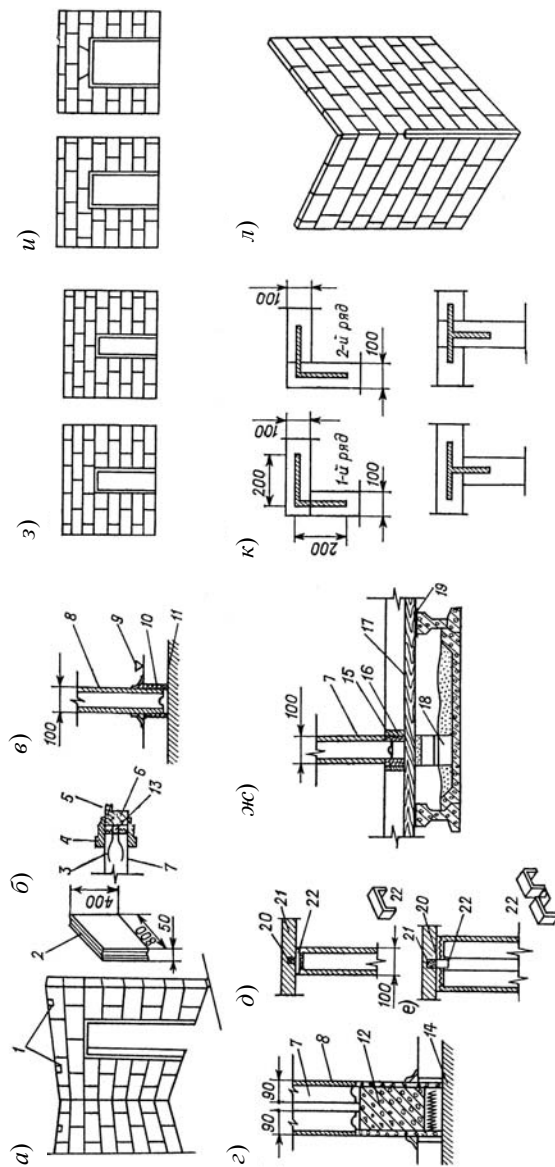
Общий вид перегородки из мелкозернистых гипсовых, гипсошлаковых и шлакобетонных плит: *a* – общий вид; *б* – крепление дверной коробки к перегородке; *в* – установка межкомнатной перегородки на перекрытие из железобетонных плит; *г* – установка межквартирной двухслойной перегородки на опорную железобетонную балку; *д* – крепление однослойной перегородки к железобетонному перекрытию; *е* – крепление двухслойной перегородки к железобетонному перекрытию; *ж* – установка перегородки параллельно балкам перекрытия; *з* – устройство перемычек при ширине проема менее 0,8 длины плиты; *и* – устройство перемычек при ширине проема более 0,8 длины плиты; *к* – угловое и тавровое скрепление плит анкерами; *л* – сопряжение перегородок под углом; *1* – скобы крепления; *2* – гипсовая плита; *3* – печная проволока, закладываемая в шов кладки; *4* – наличник; *5* – коробка; *6* – гвоздь $L = 100$; *7* – плита; *8* – затирка; *9* – уровень чистого пола; *10* – звукоизоляционная прокладка; *11* – раствор; *12* – железобетонная балка; *13* – заделка паклей, пропитанной в растворе; *14* – железобетонное покрытие; *15* – брусок 5×8 см; *16* – доска $\delta = 30$ мм; *17* – лага под перегородку $h = 50$ мм; *18* – звукоизоляционная диафрагма из кирпича; *19* – толь; *20* – гвоздь 4–5 мм; *21* – деревянная пробка; *22* – металлическая скоба
